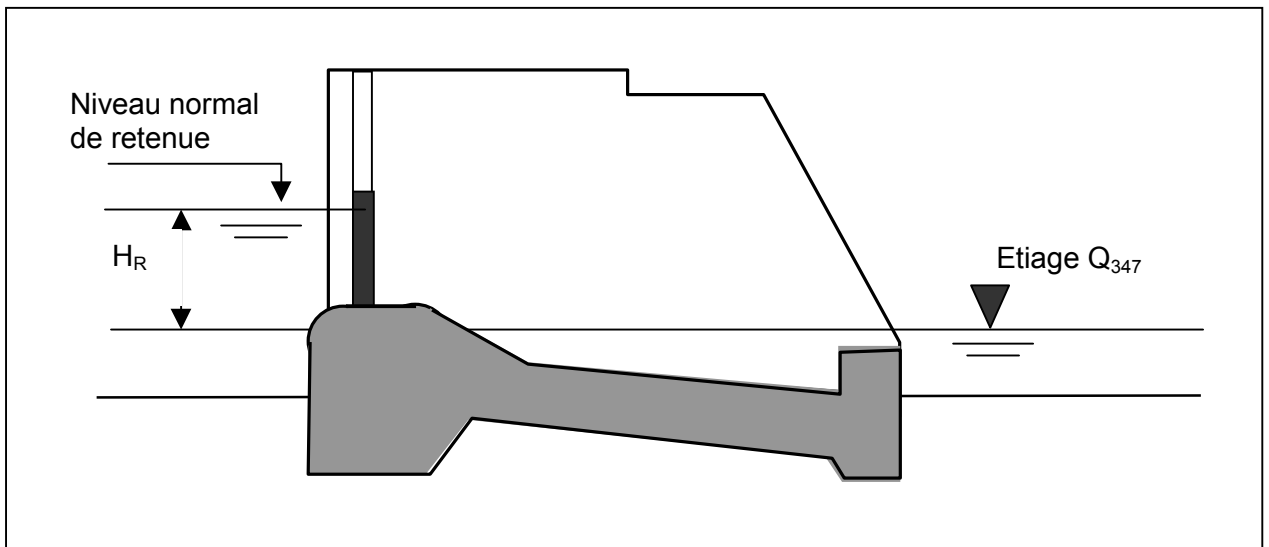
Définition de la hauteur de retenue (H_R) d'un barrage en rivière
